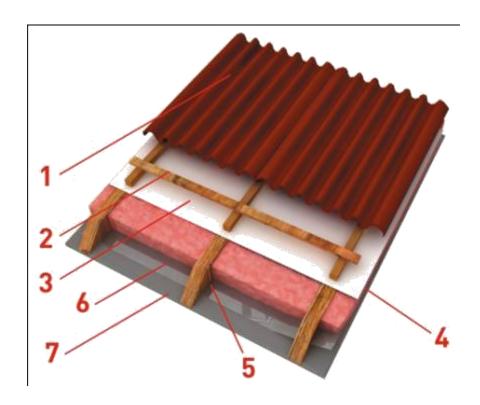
Структура скатной кровли: 1 – черепица или другой кровельный материал; 2 – шаговая (поперечная) обрешетка; 3 – ветро- и влагозащитная мембрана; 4 – слой утеплителя; 5 – стропила; 6 – слой пароизоляции; 7 – слой внутренней отделки
